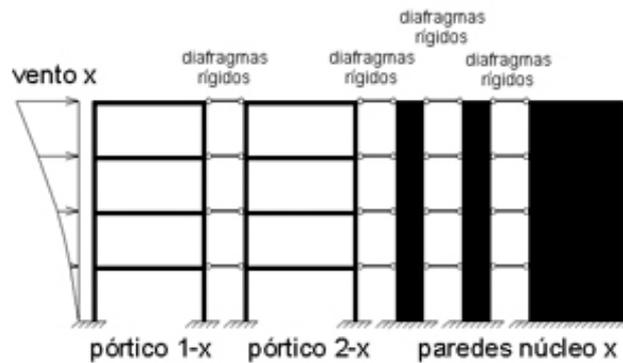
Composição dos pórticos planos e paredes do núcleo na direcção x [26]
